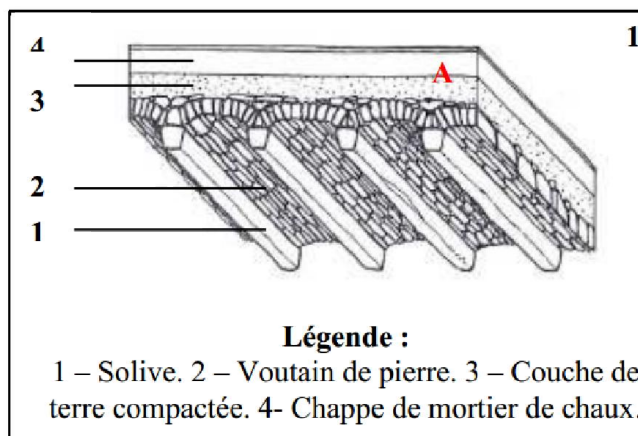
Consistance d'un plancher à voutains de pierres, et revêtement en terre et chaux. (Source : Idir, 2013)
